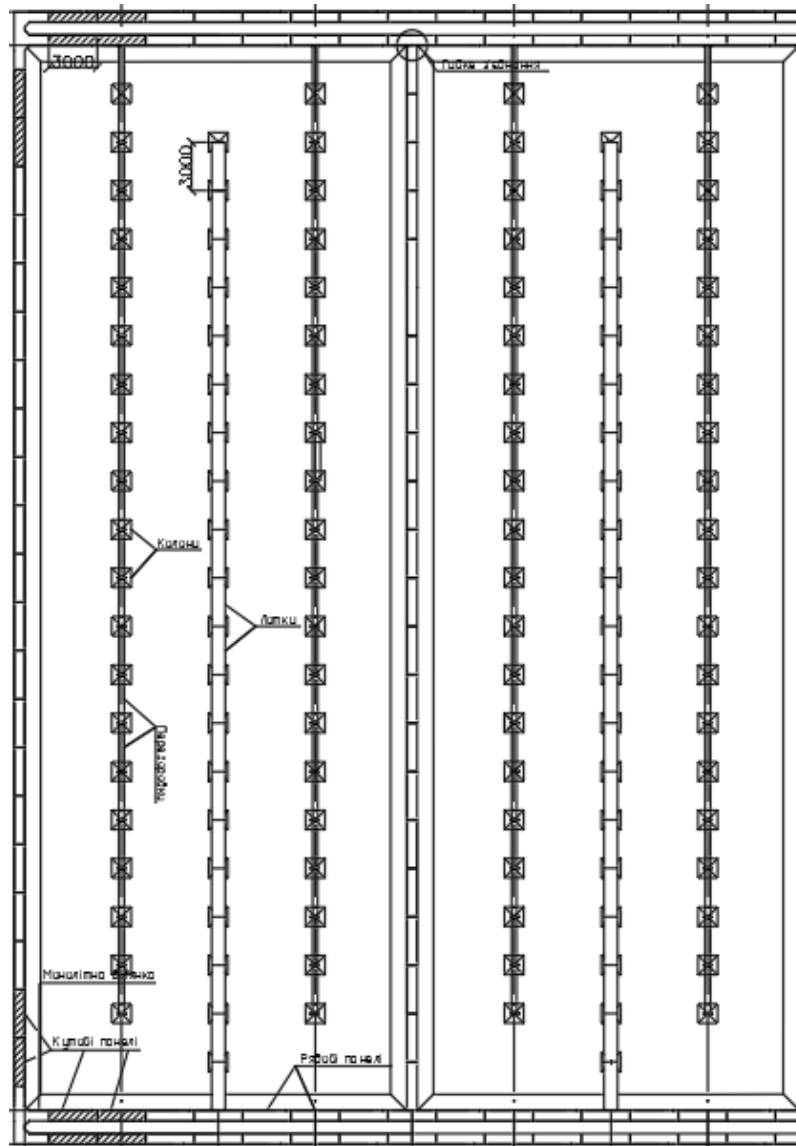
Схематичний план аеротенку з маркуванням конструкцій каркаса
